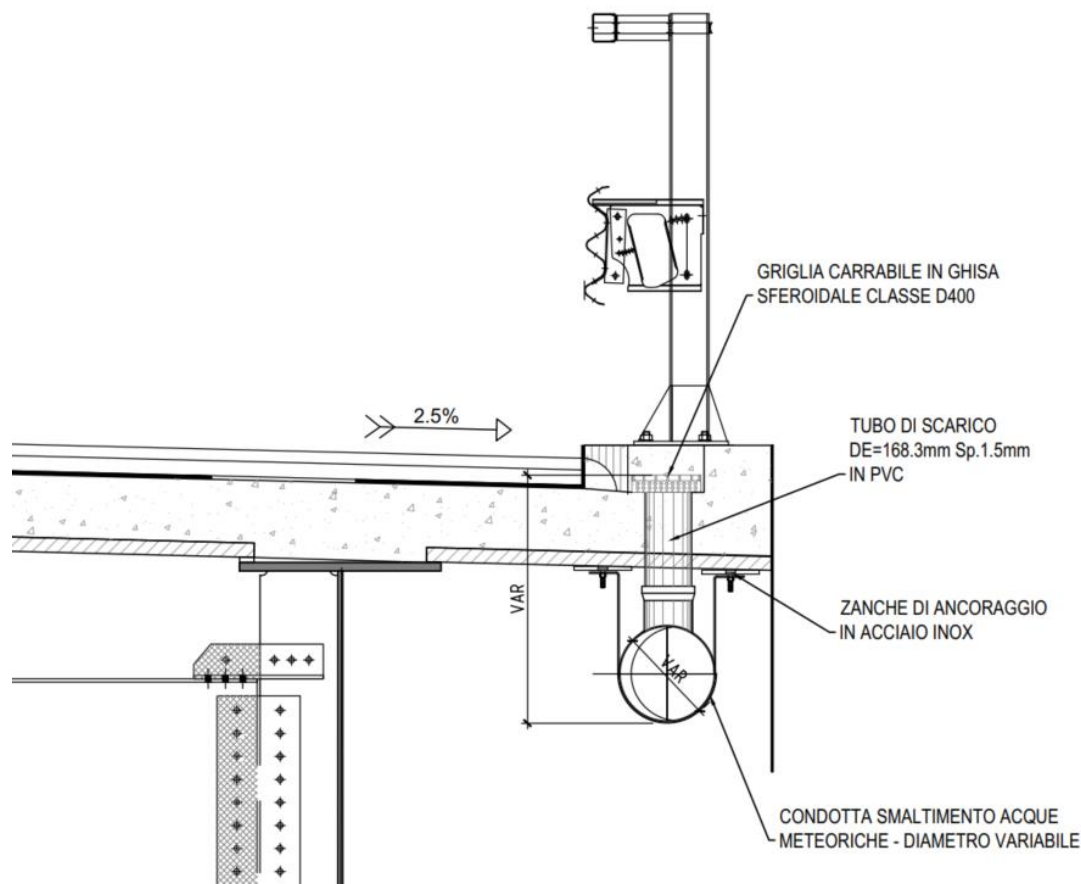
Sezione tipo viadotti con sistema di drenaggio
